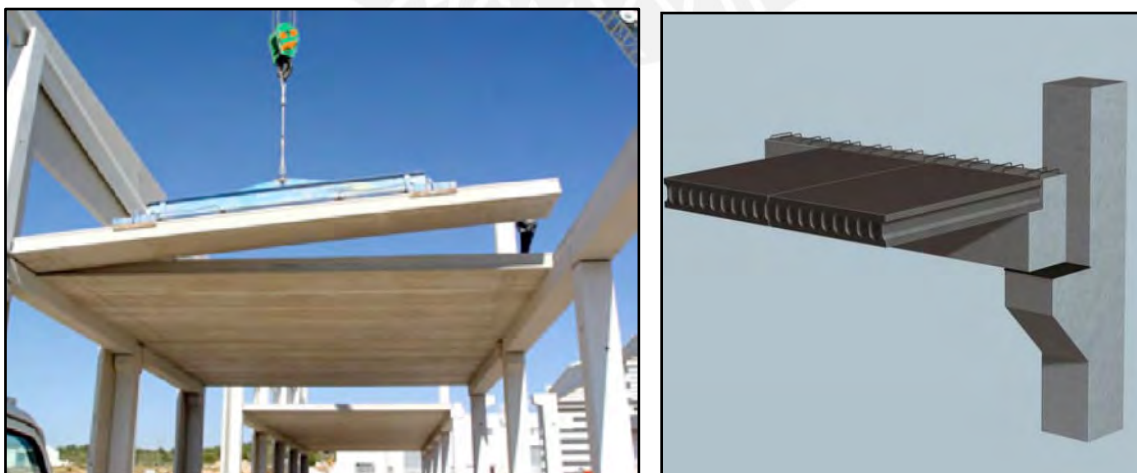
Ensamblado de losa alveolar con la viga pretensada (Tecnyconta, n.d).
